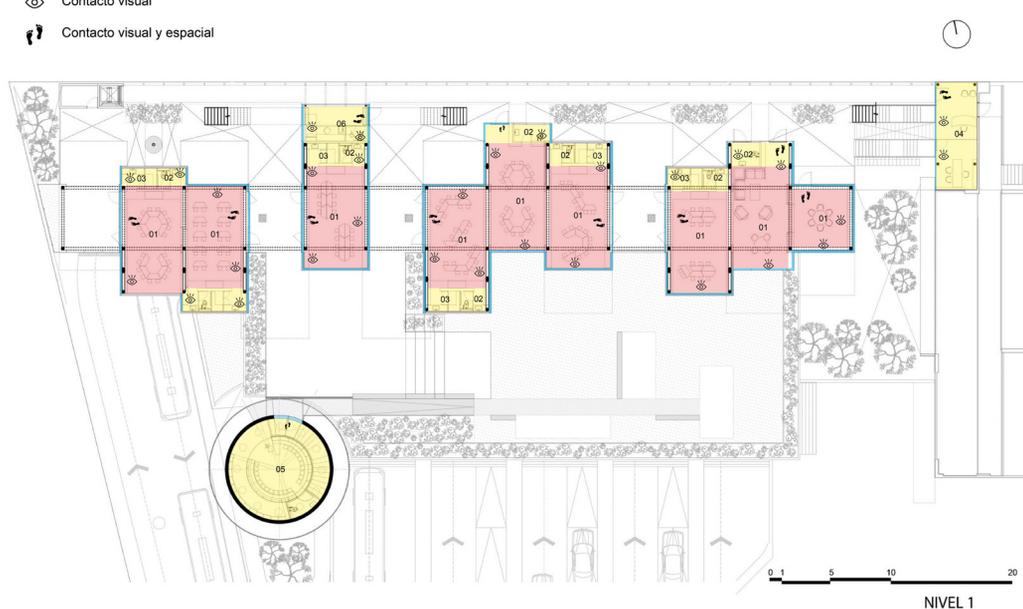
Planta arquitectónica nivel 1; escuela colegio Hebreo Monte Sinaí
